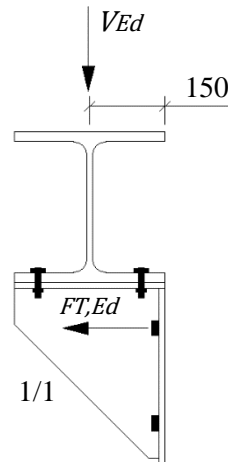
Modelo de cálculo, ligação perfil/maciço, para HEB 400 [mm]
